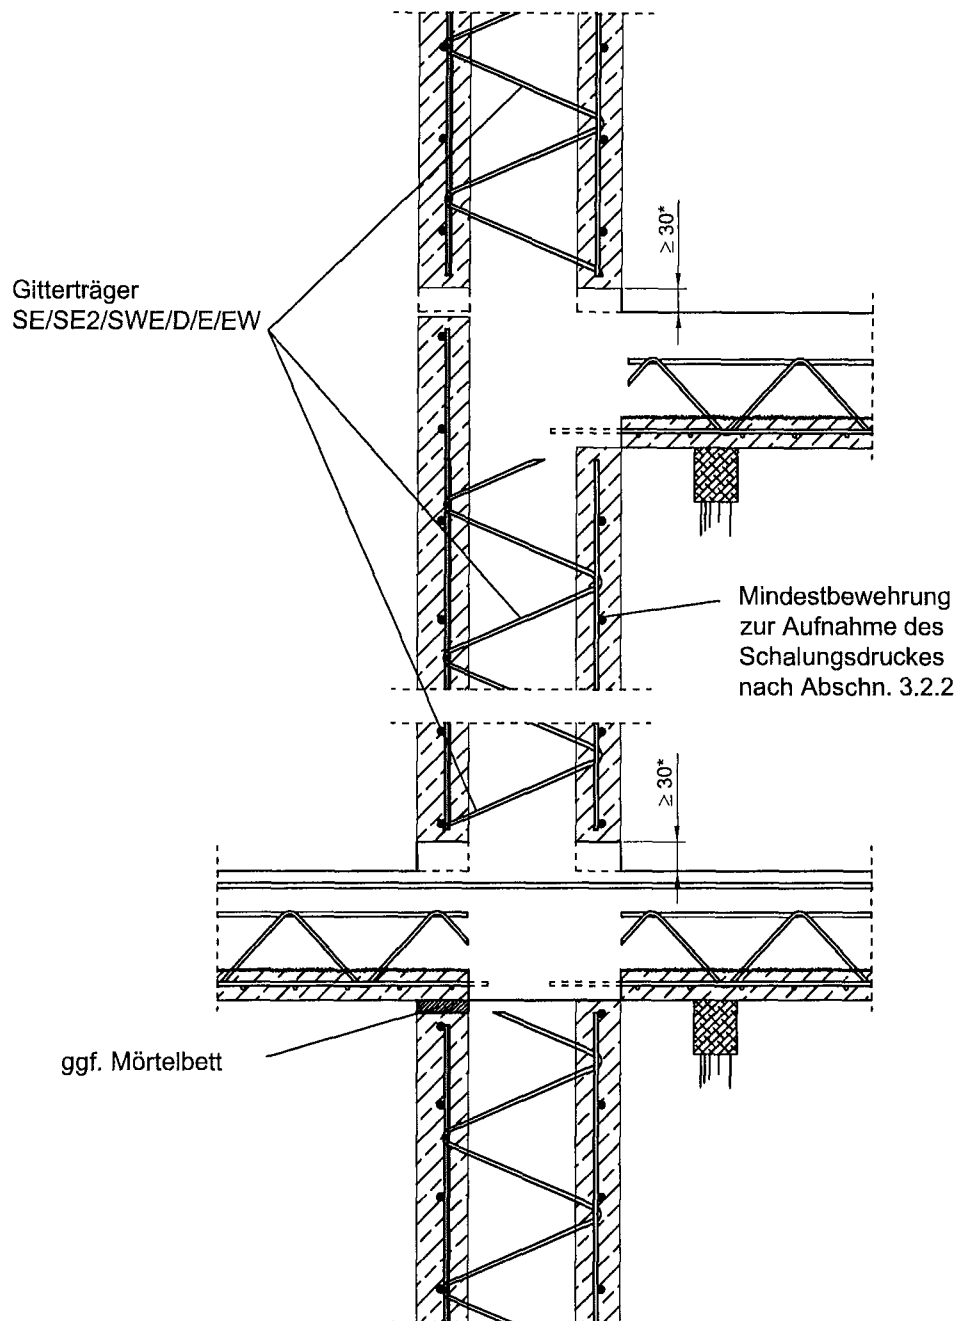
Außen- und Innenwandanschluss gelenkige Lagerung
